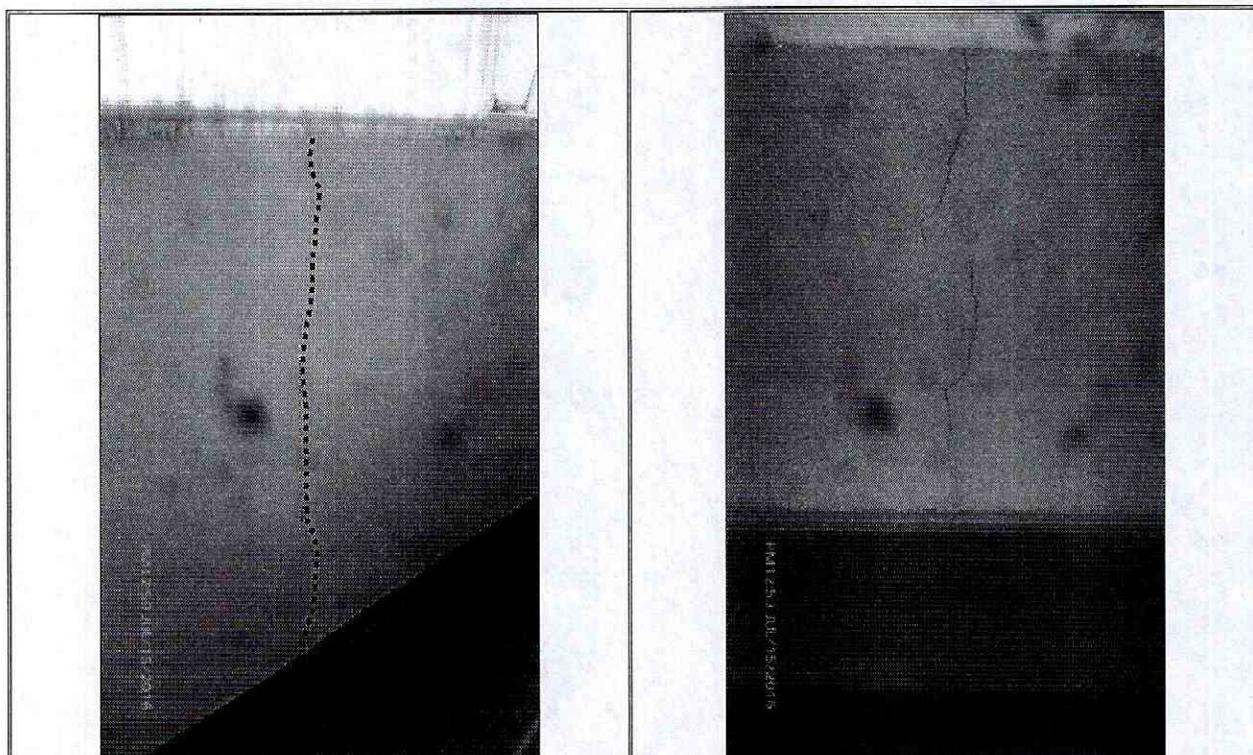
Separaciones identificadas entre las escaleras y los muros de cerramiento en las unidades habitacionales identificadas "Escalera 19" y "Escalera 26".
